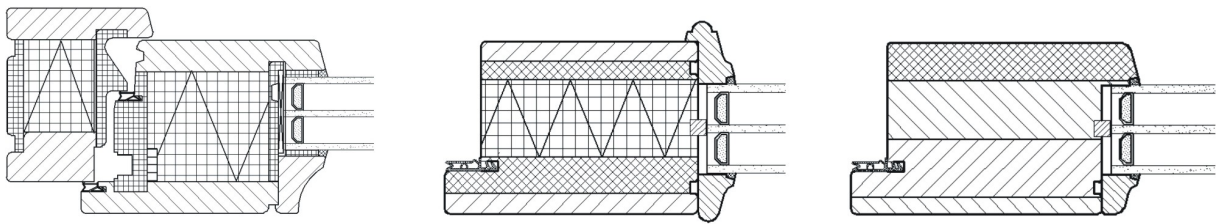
Holzrahmen mit Sandwichaufbau (links [59], Mitte [97]) und rechts mit Außendämmung [74]
